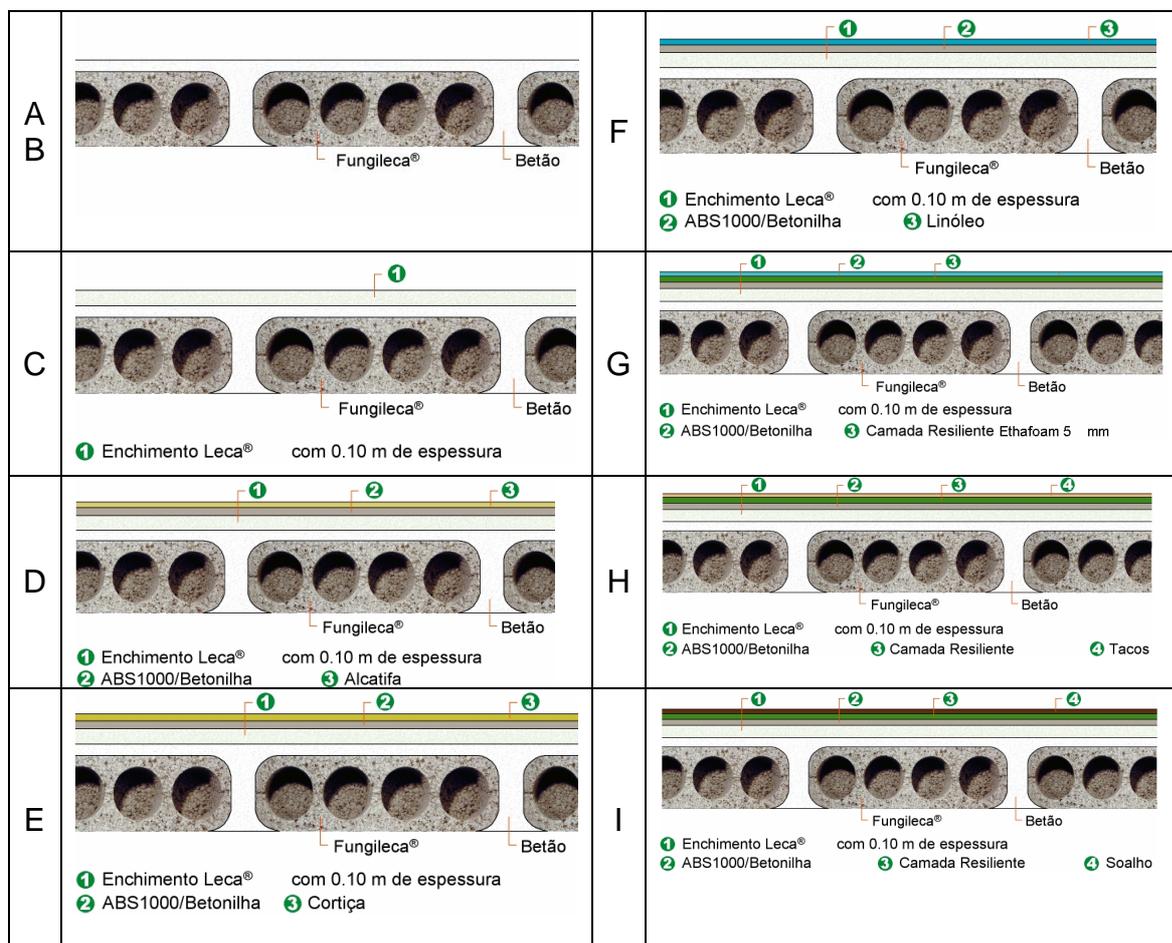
Secções transversais dos provetes da primeira “bateria” de ensaios
